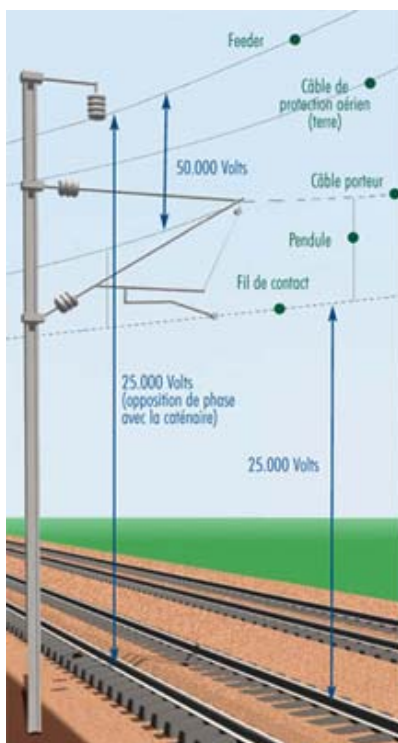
Schéma général d'une implantation de caténaire en pleine voie
